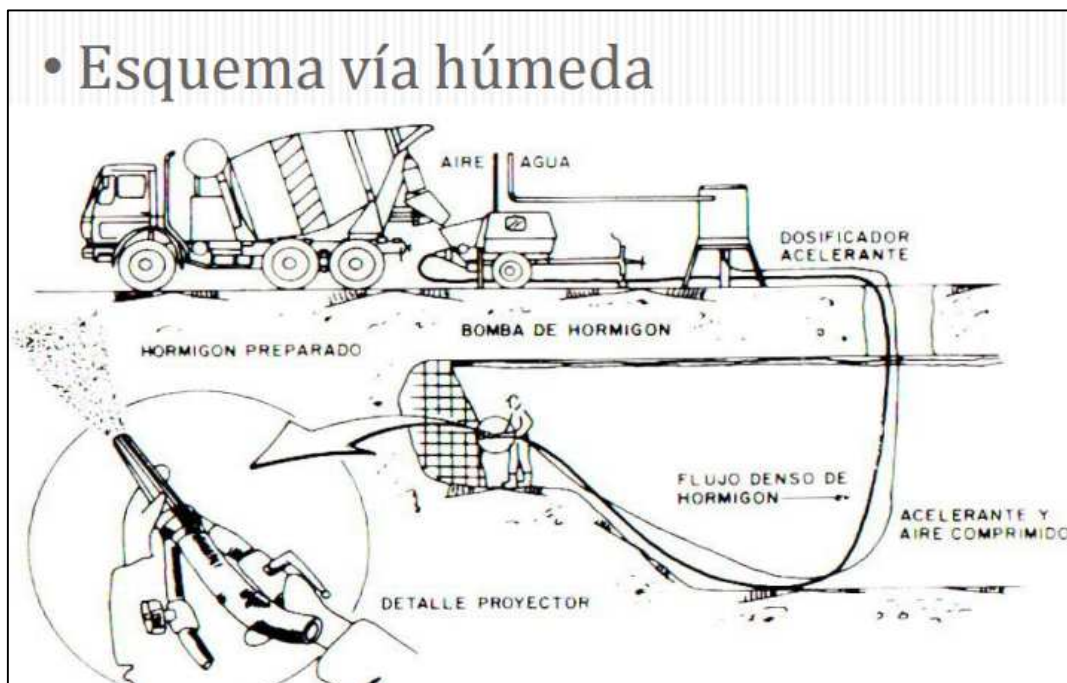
Esquema del procedimiento Hormigón Proyectado
